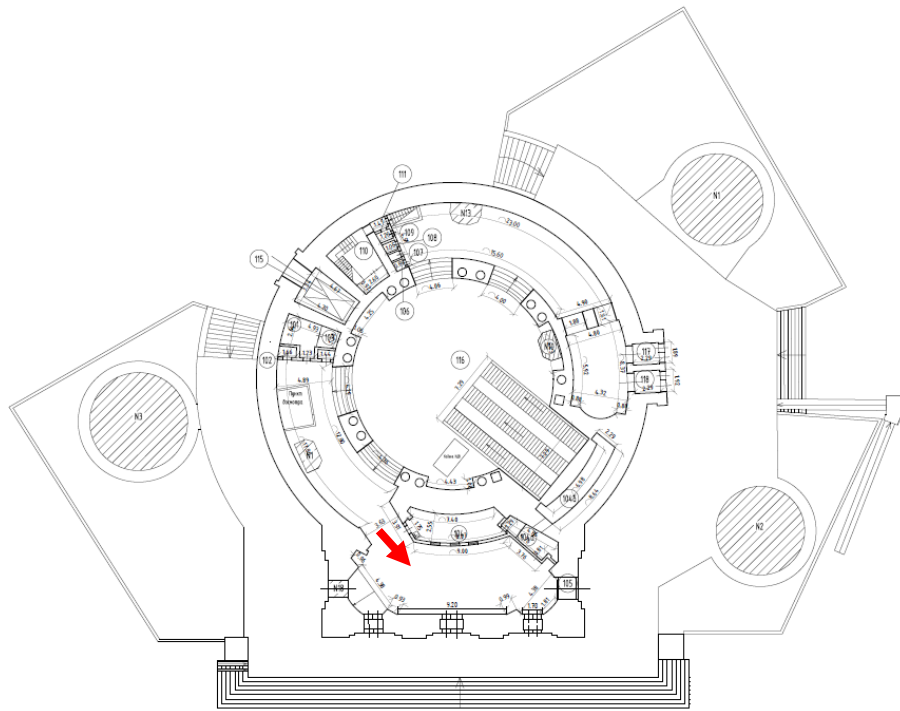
Первый этаж, вестибюль, главный вход со стороны северо-западный фасад здания.
